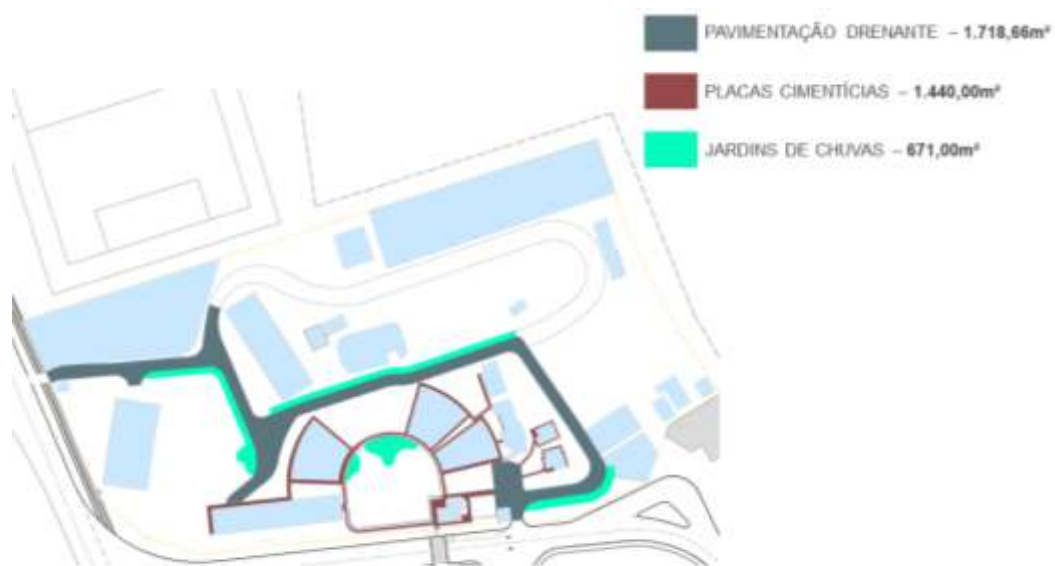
Esquema de distribuição da Pavimentação Drenante e Jardins de Chuva
